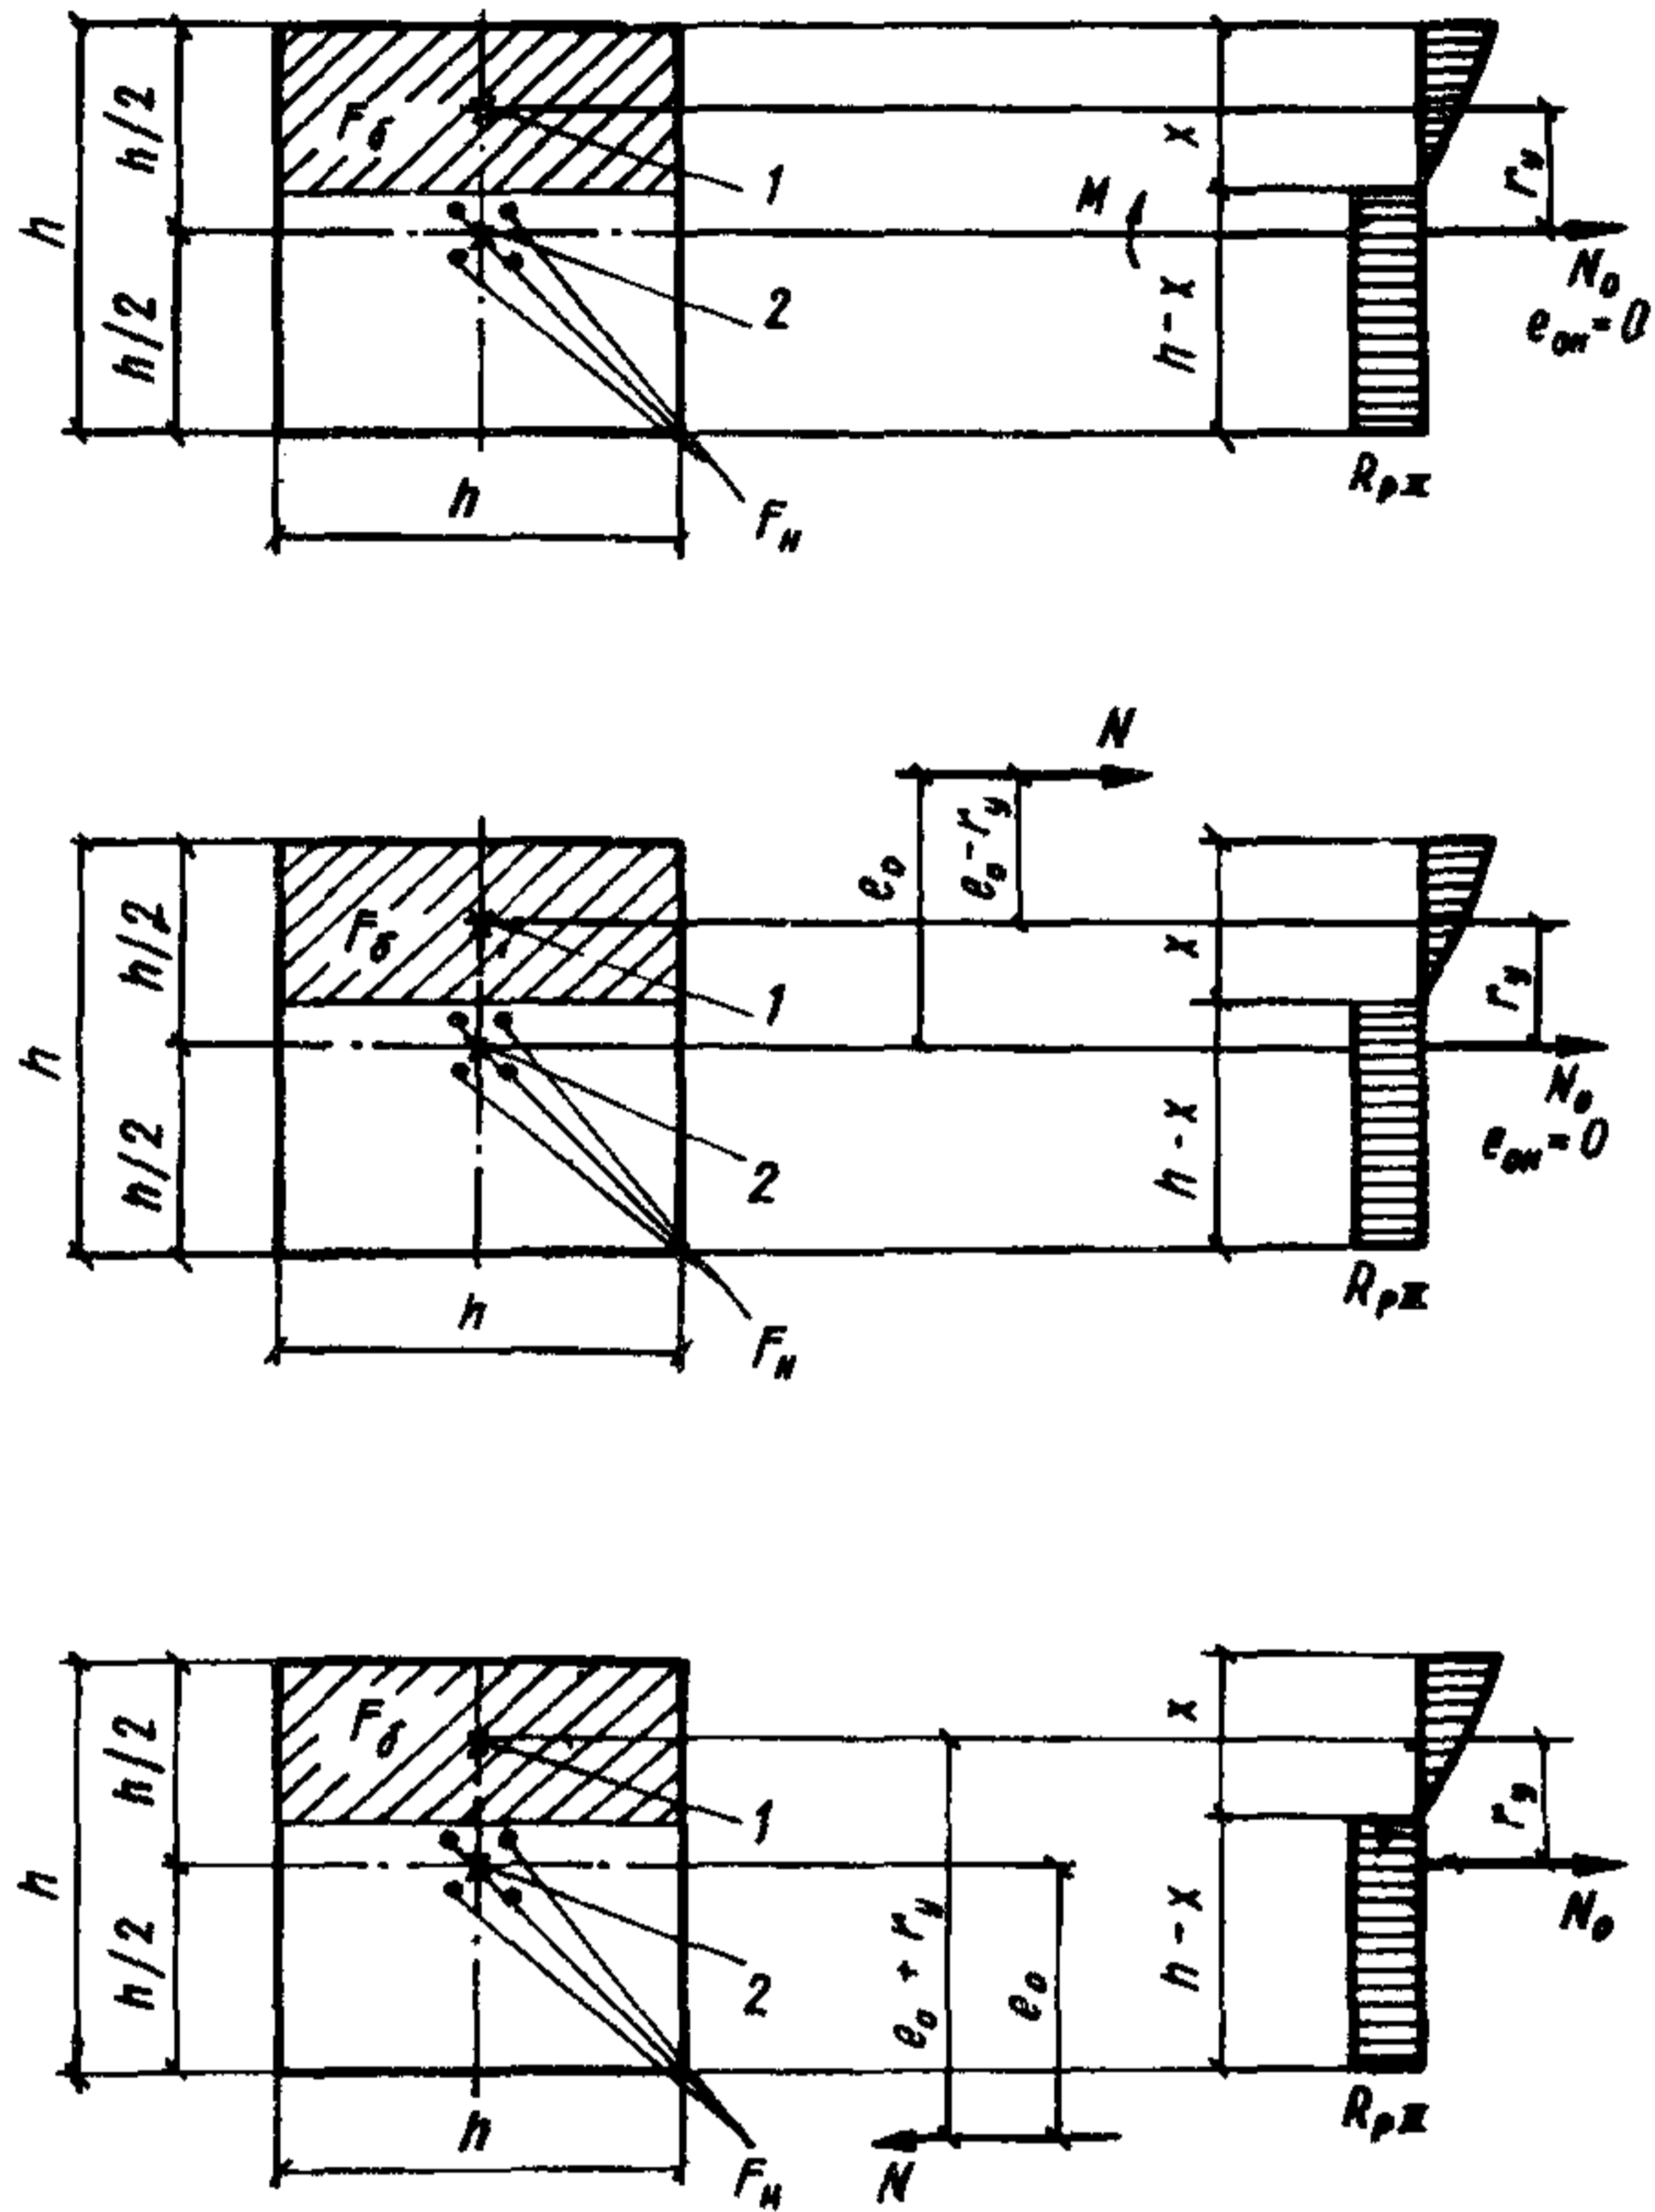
Схема усилий и эпюра напряжений в поперечном сечении свай при расчете его, по образованию трещин, нормальных к продольной оси свай при изгибе (а), при внецентренном сжатии (б) и внецентренном растяжении (в)
